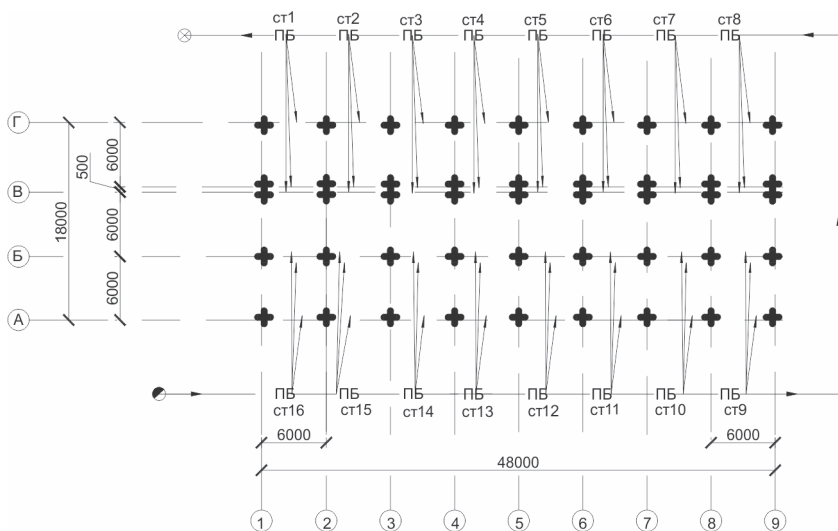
Схема проходки крана в процессе монтажа подкрановых балок
